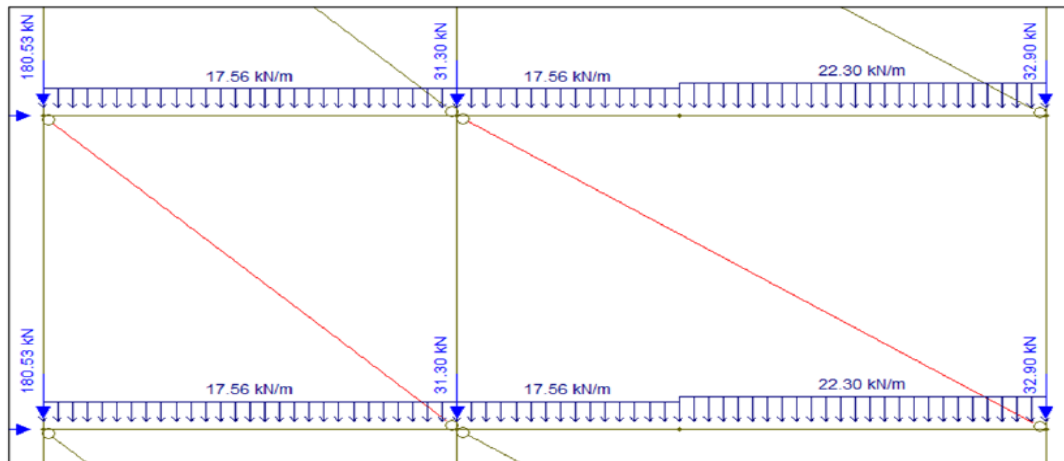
Detalhe das cargas aplicadas em cada pavimento
